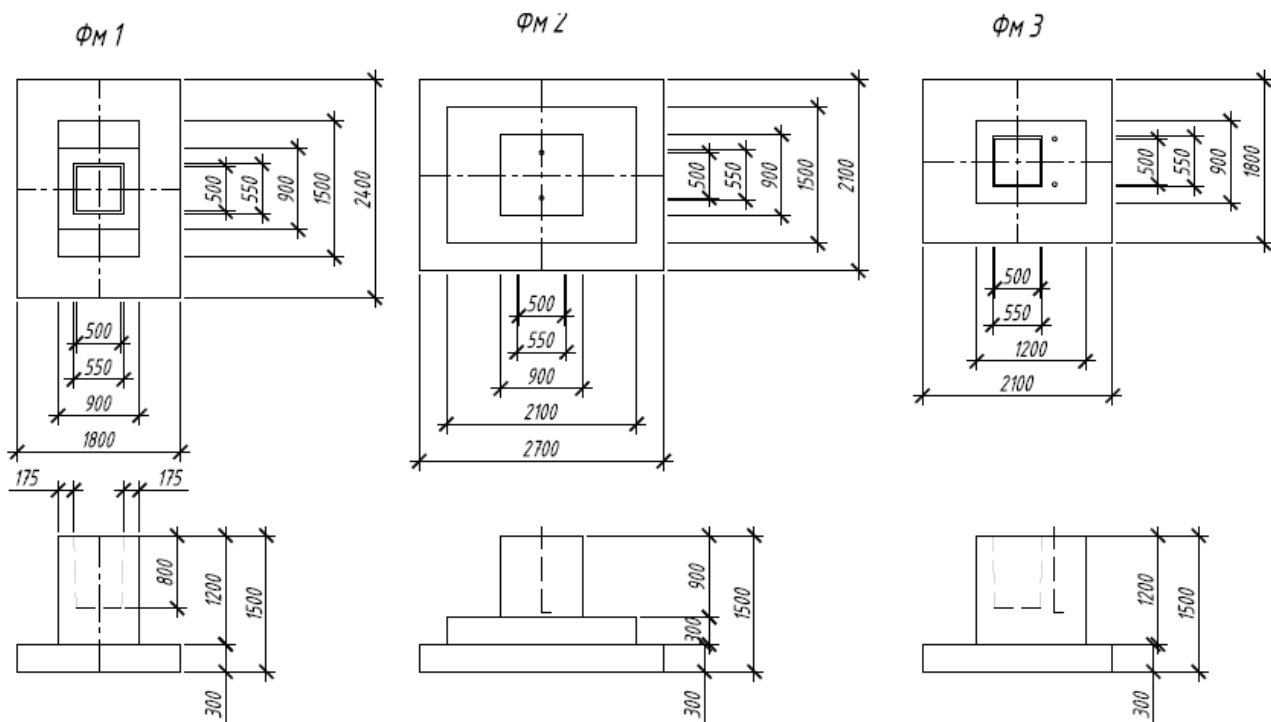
Залізобетонні монолітні фундаменти
